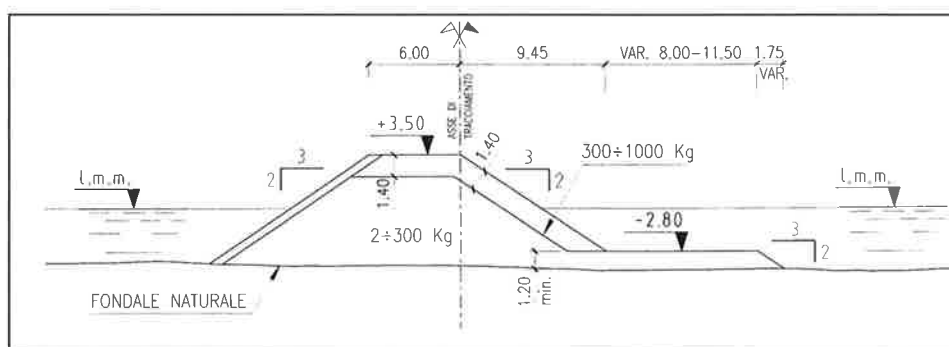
CONTERMINAZIONE LATERALE DELL'ISOLA: SEZIONE TIPO
